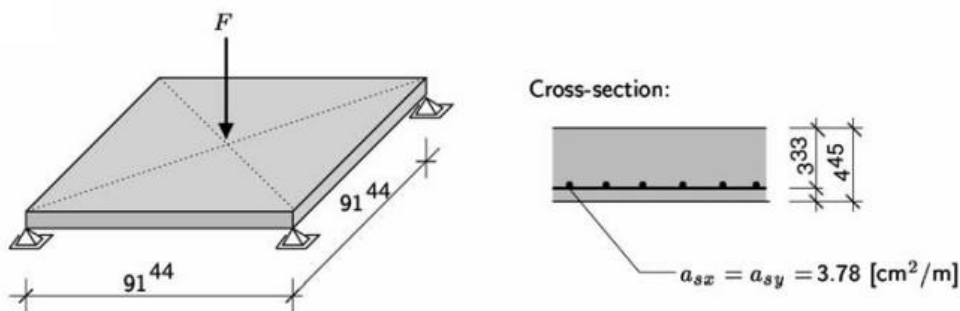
Dimensões (em cm) e armaduras da laje do Exemplo 2
